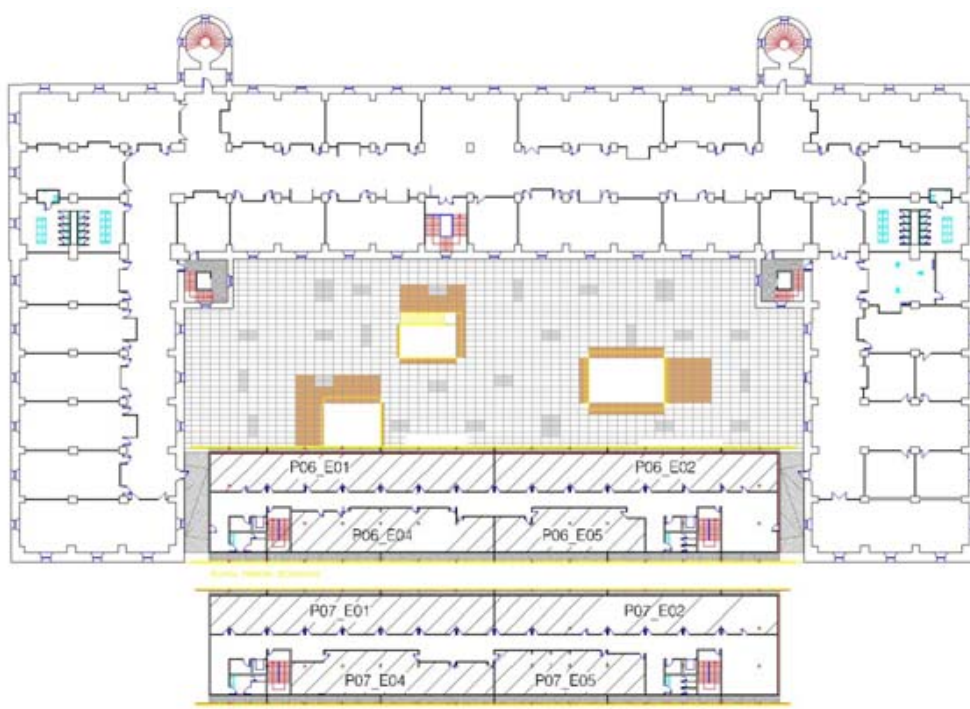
Agrupación de zonas primera y segunda planta del edificio nuevo.
